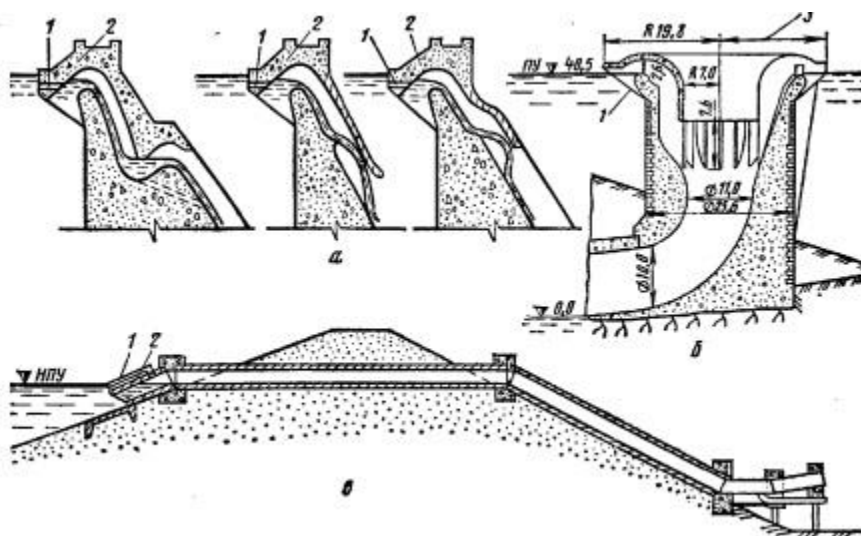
Сифонные водосбросы: а – типы сифонных водосбросов, б – башенный сифонный водосброс гидроузла, в – трубчатый сифонный водосброс в теле грунтовой плотины, 1– специальные отверстия, 2– капер, 3– разрез по отверстию для сброса сора.
